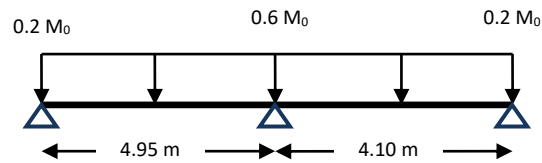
Dimensions des poutrelles du plancher en corps creux.
